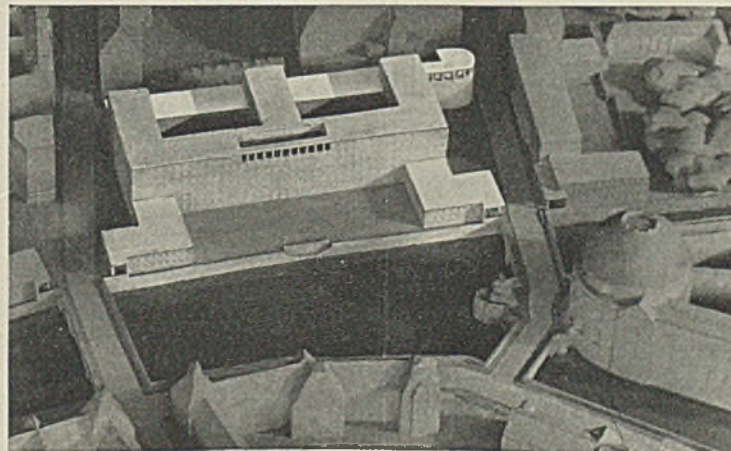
Geplante Gesamtbebauung mit Einbeziehung des jetzt errichteten Bauteiles (weißes Dach).
